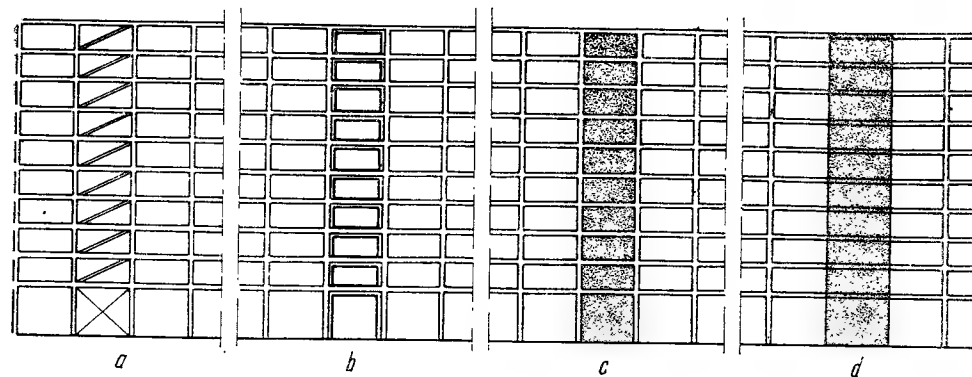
Scheme de contravîntuire la structuri cu stîlpi și planșee dală :
